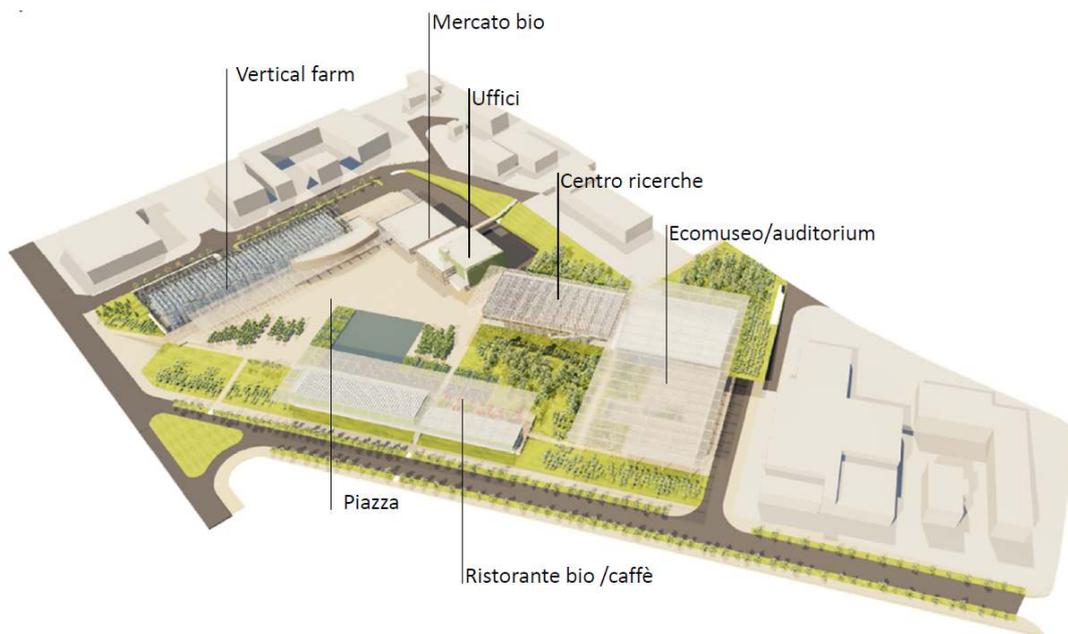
Planivolumetrico dell'area d'intervento (nostra elaborazione).
